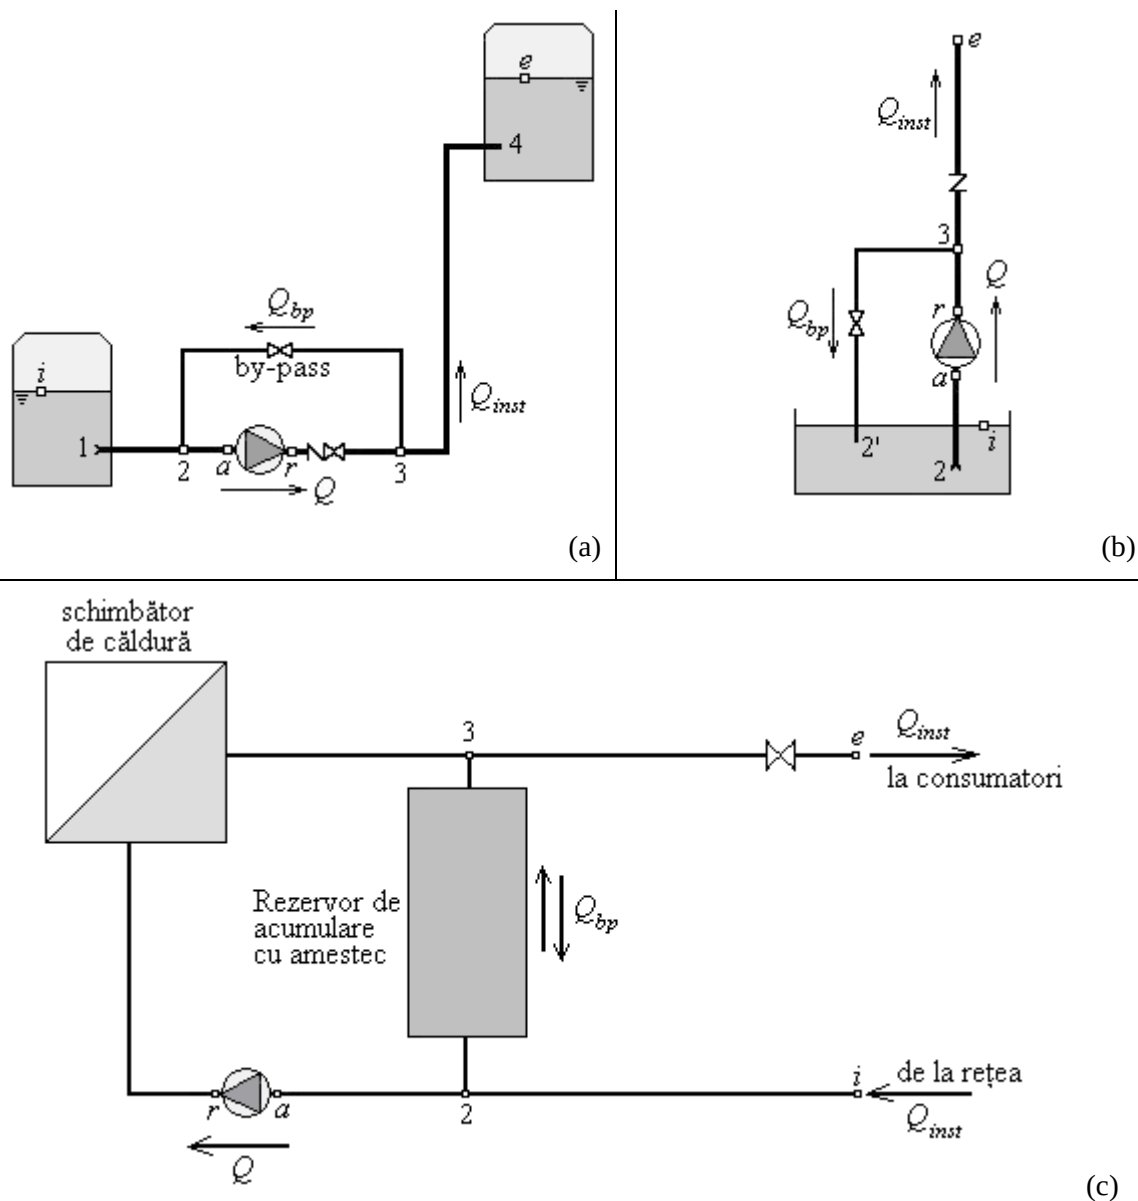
Instalație hidraulică cu conductă de by-pass montată în cazul unei: (a) pompe centrifuge; (b) pompe axiale; (c) instalații de preparare a apei calde cu acumulare prin amestec
